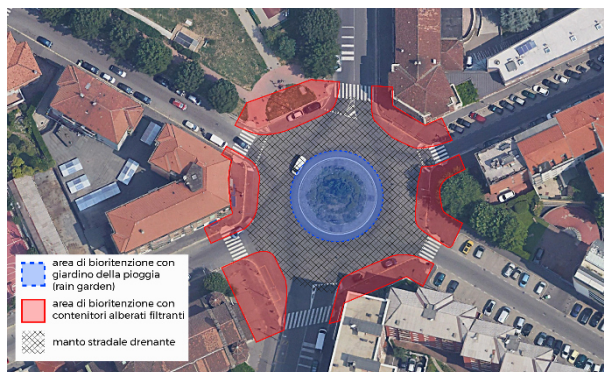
Area oggetto degli interventi di depavimentazione e SuDS in Piazza Caserta
